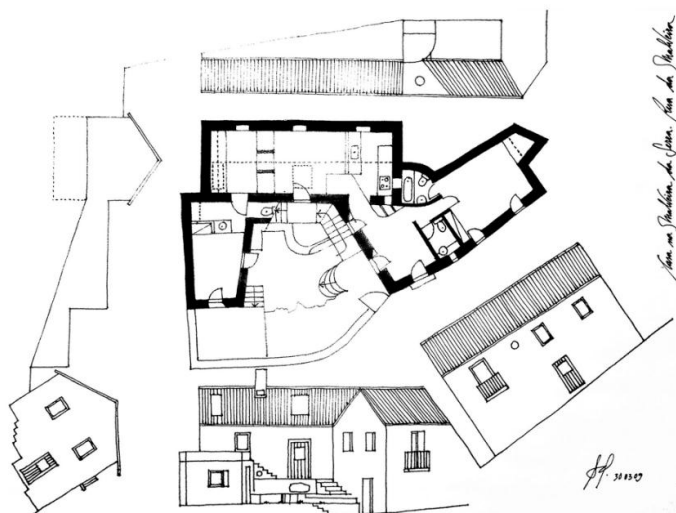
Planta e Alçados, “*Casa em Forma de Abraço*”, Pedro Quintela.
